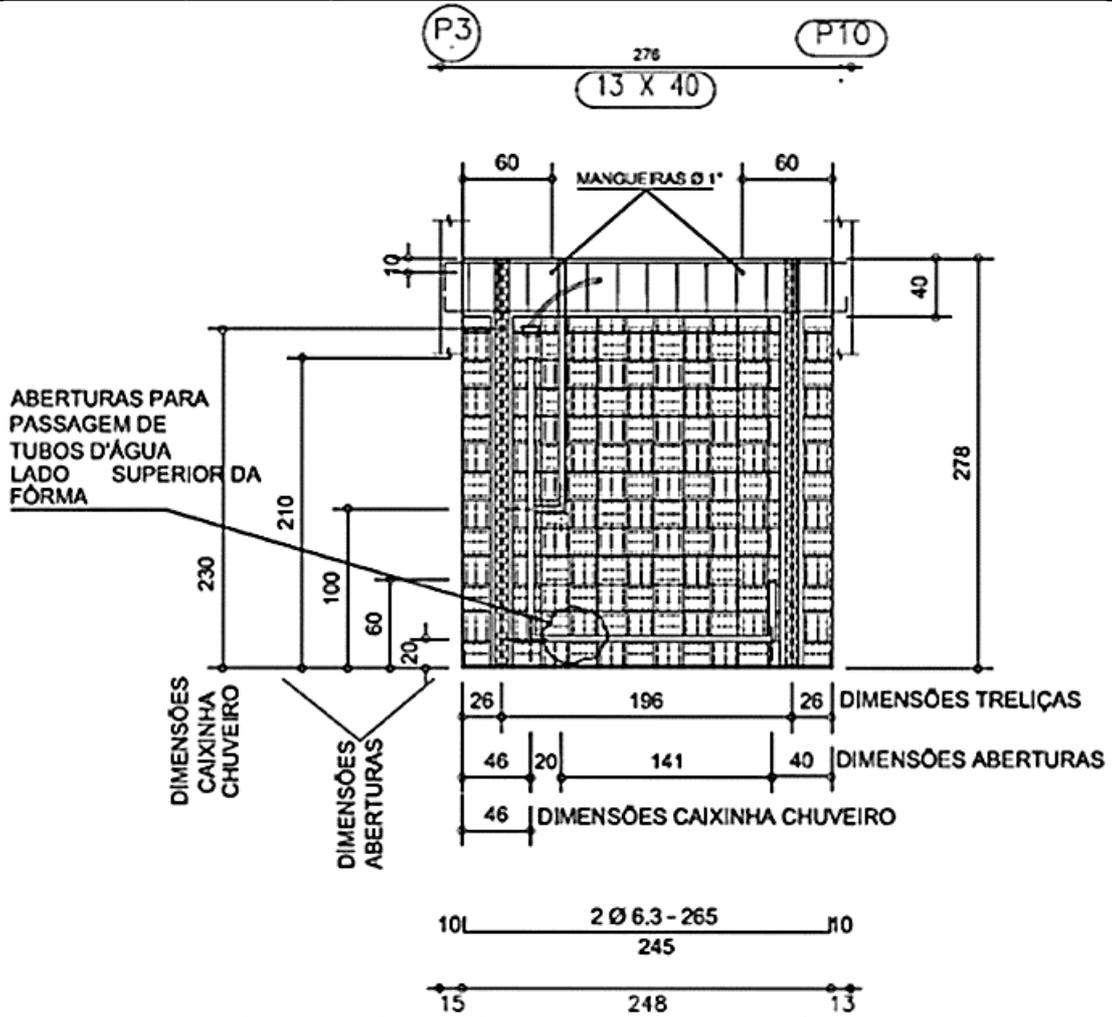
Painel pré-moldado com tubulação hidráulica.
